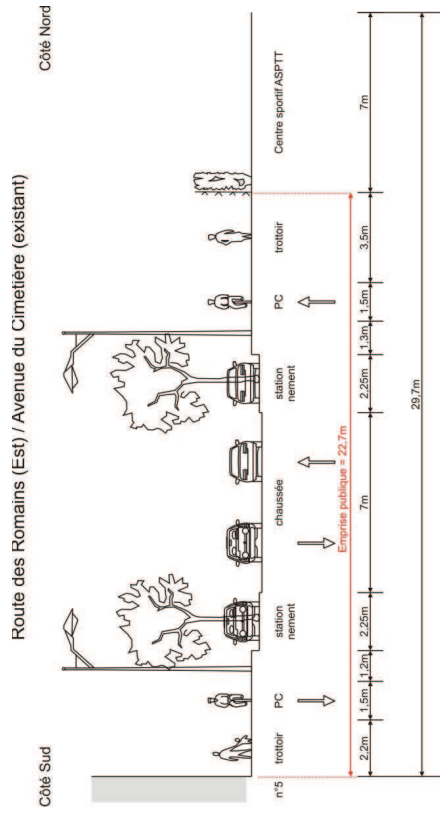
Situation initiale - coupe 1 (Route des Romains juste à l'Est du débouché de l'avenue du Cimetière)
